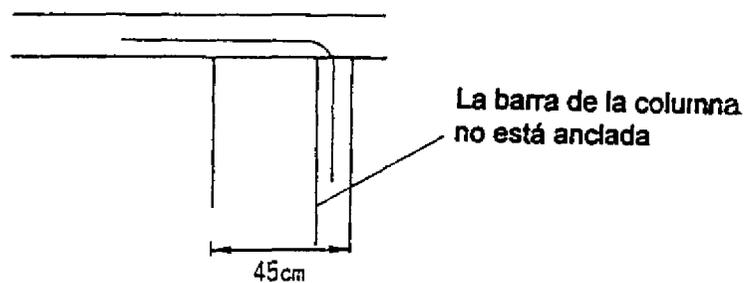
Detalle de la unión entre la columna de soporte y la losa de la estructura de la techumbre (detalle 2, de la Figura 14)
